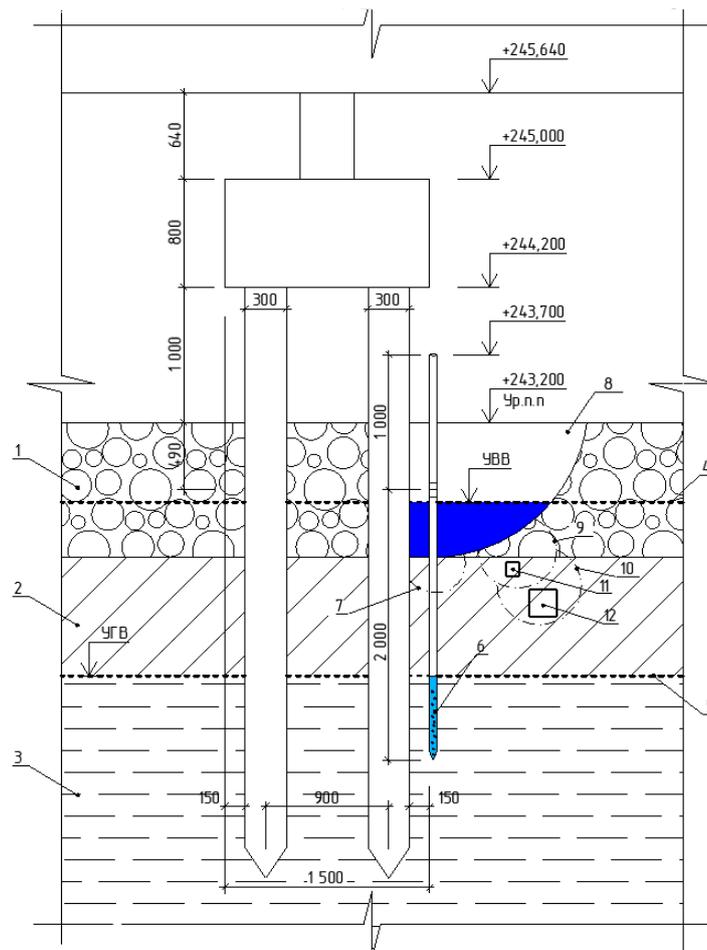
Наблюдательная скважина в приемке с верховодкой:
